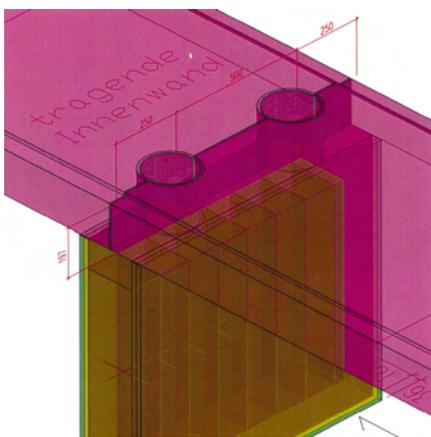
Isometrie der Deckenaufleger mit Betonstempeln
